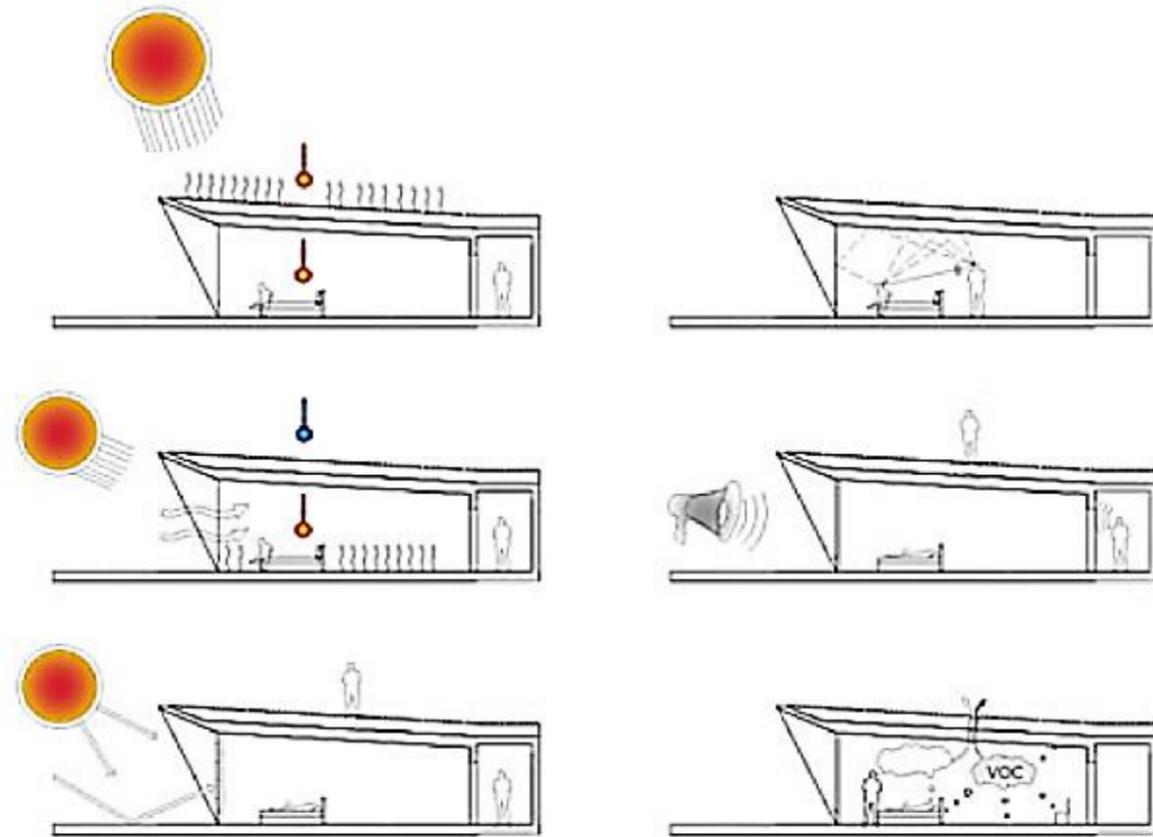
Planta de Cabañas de Klimahotel - Fuente:
